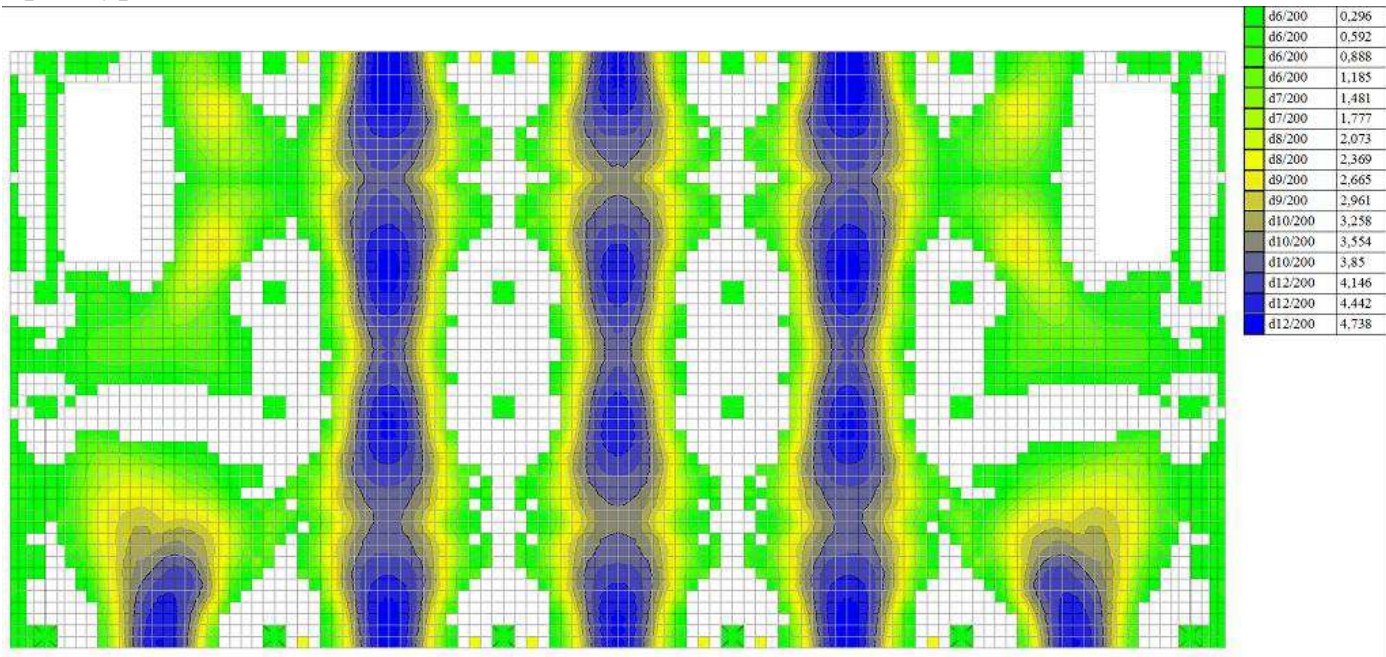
Схема нижнего армирования плиты по оси x.
